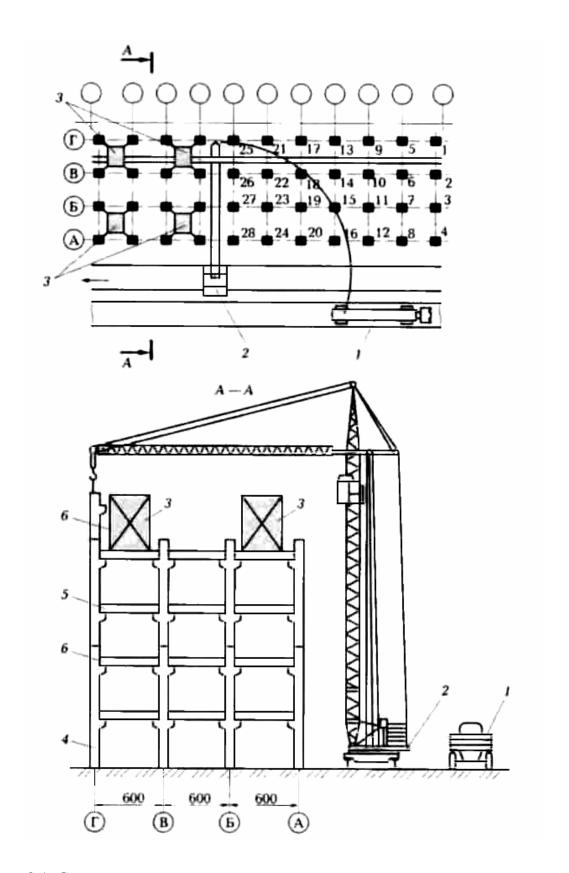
Схема организации возведения многоэтажного каркасного здания: 1 — транспортные средства; 2 — кран; 3 — кондуктор; 4 — колонна; 5 — балки; 6 — плиты перекрытия (1...28 — очередность монтажа колонн)
